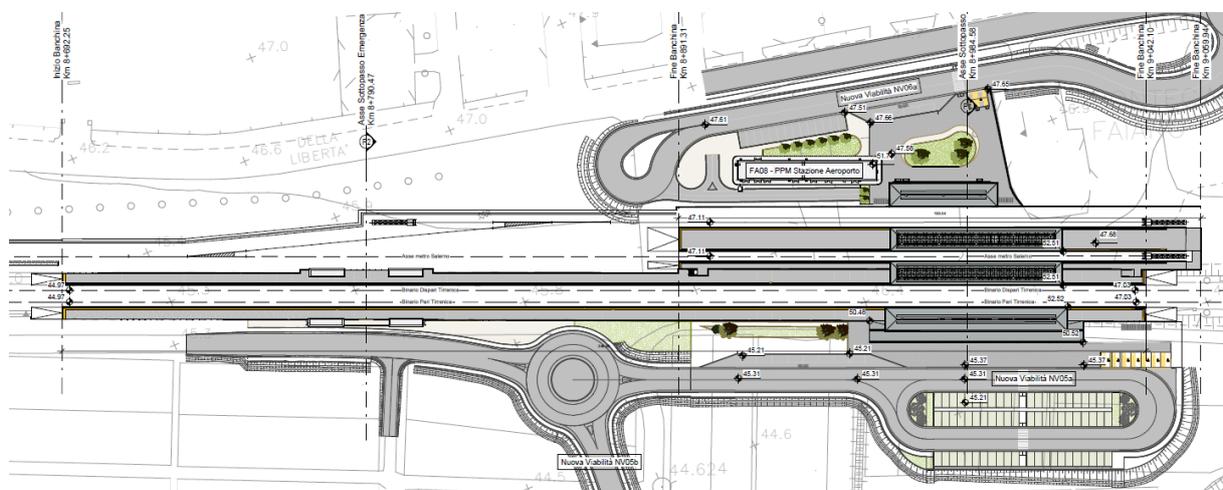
Planimetria generale della Fermata Pontecagnano Aeroporto
